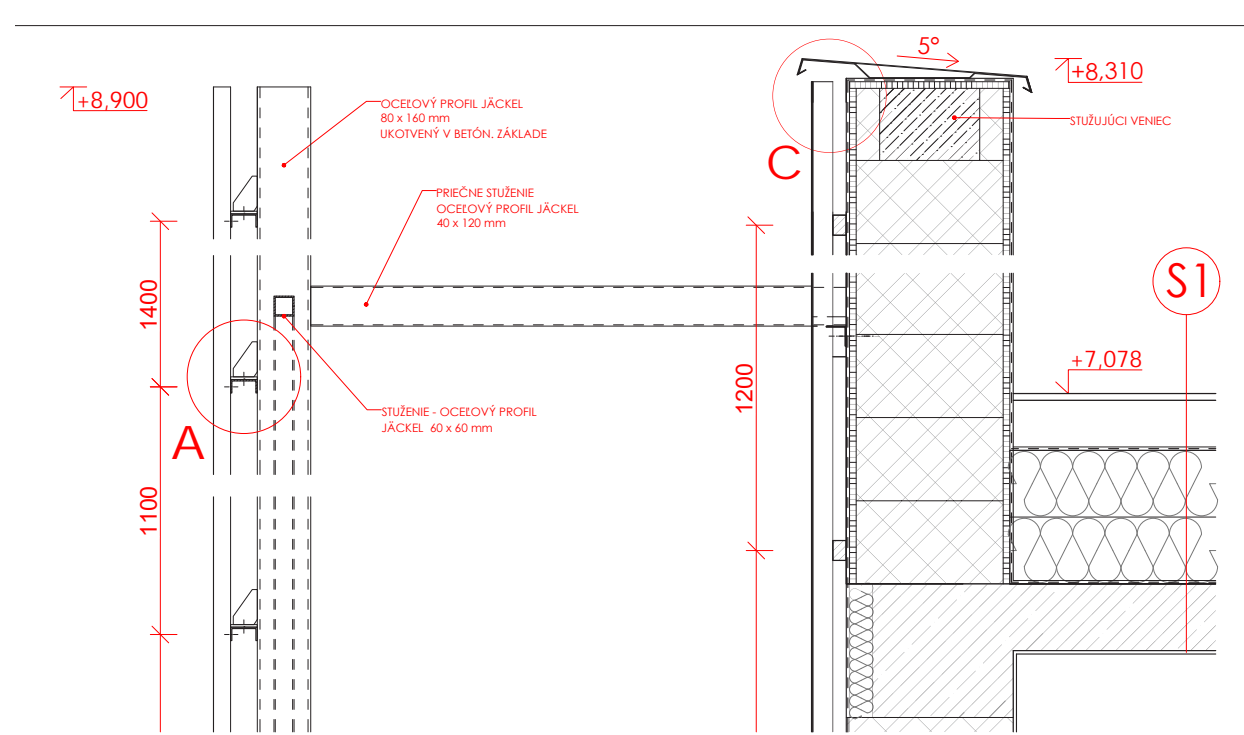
DETAIL UKOTVENIA OCEĽOVÉHO ROŠTU DO STROPU
